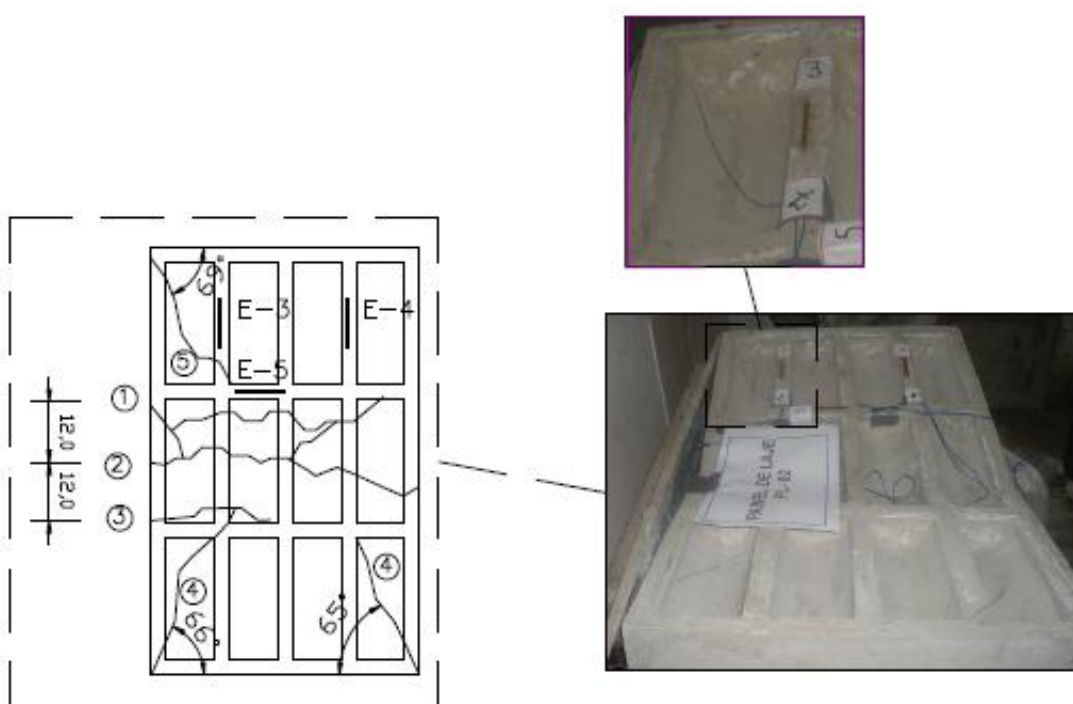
Detalhe dos posicionamentos de fissuras de PL-02
